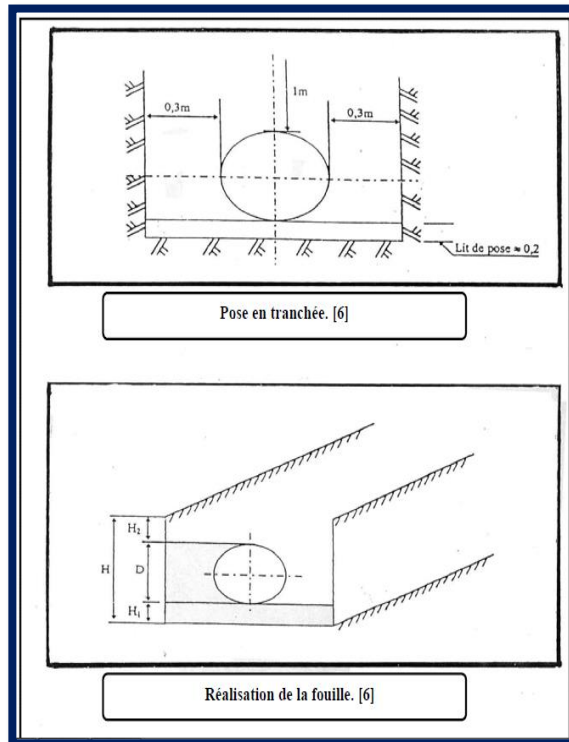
Schéma d'une tranchée avec une conduite circulaire
